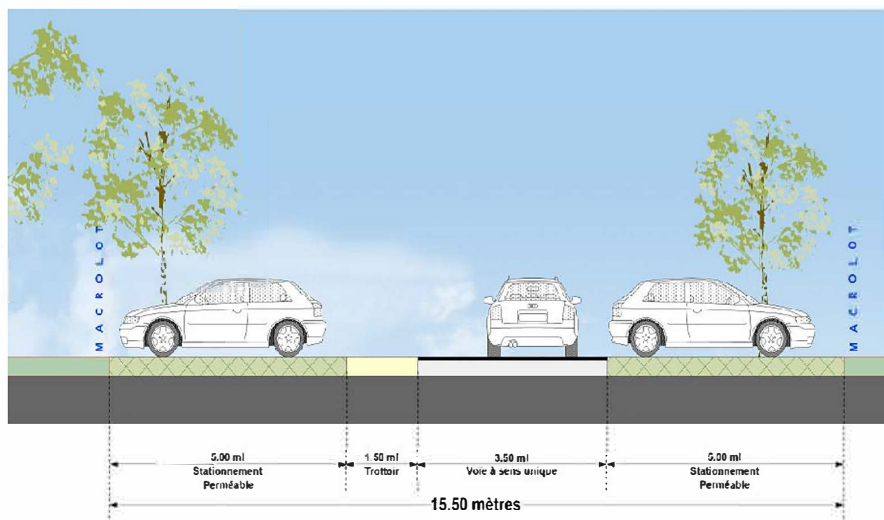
Coupe de voie secondaire (sens-unique) (coupe de principe), après modification
